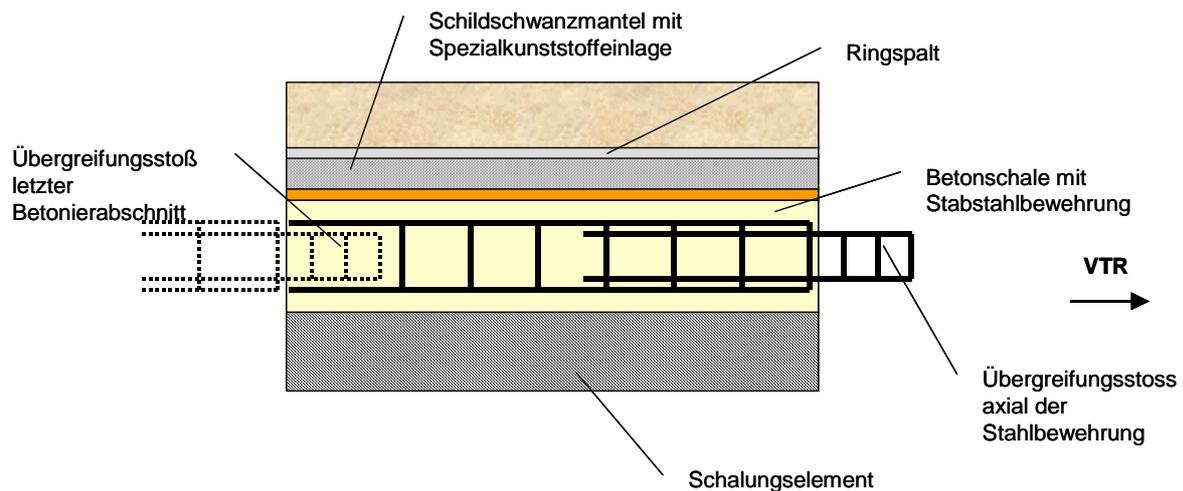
Bettung der Betonschale im Schildschwanzbereich
